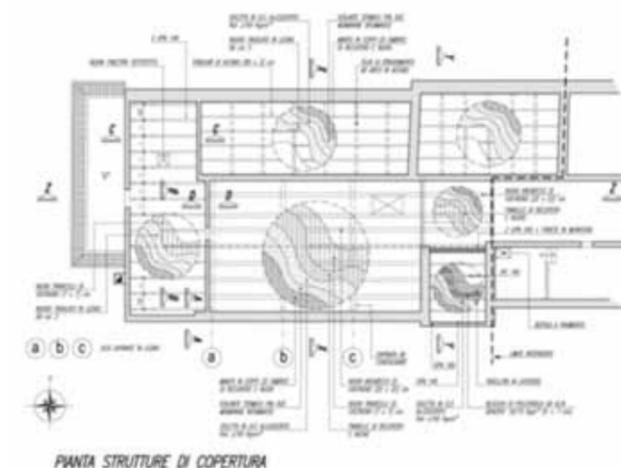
a – Consolidamento di una copertura a capriate lignee. Pianta degli elementi componenti.
